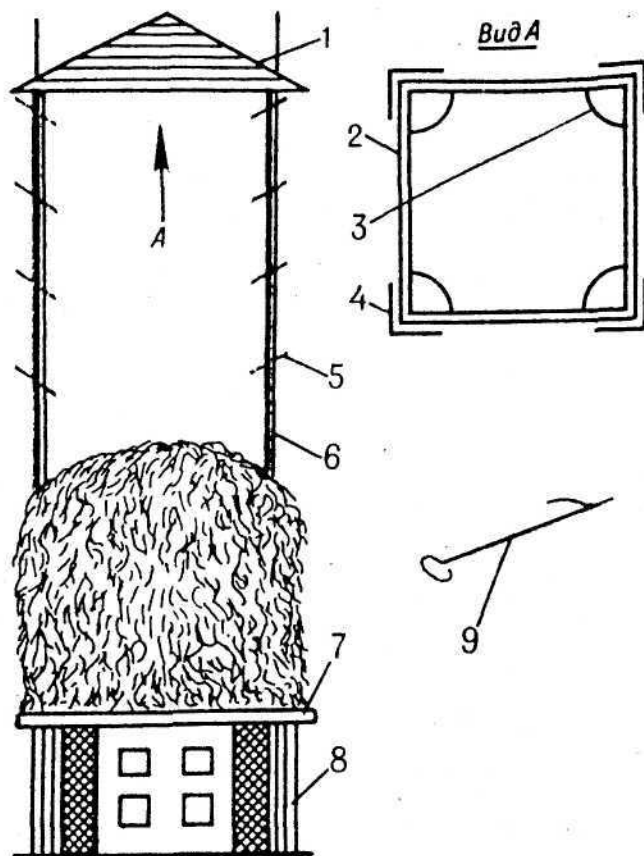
1 — крыша, 2 — передвижная рама крыши, 3 — дуга, 4 — обшивка из металла, 5 — штырь, 6 — столб высотой 7–7,5 м, 7 — настил, 8 — столб высотой 1 м, 9 — крючок для выемки сена
